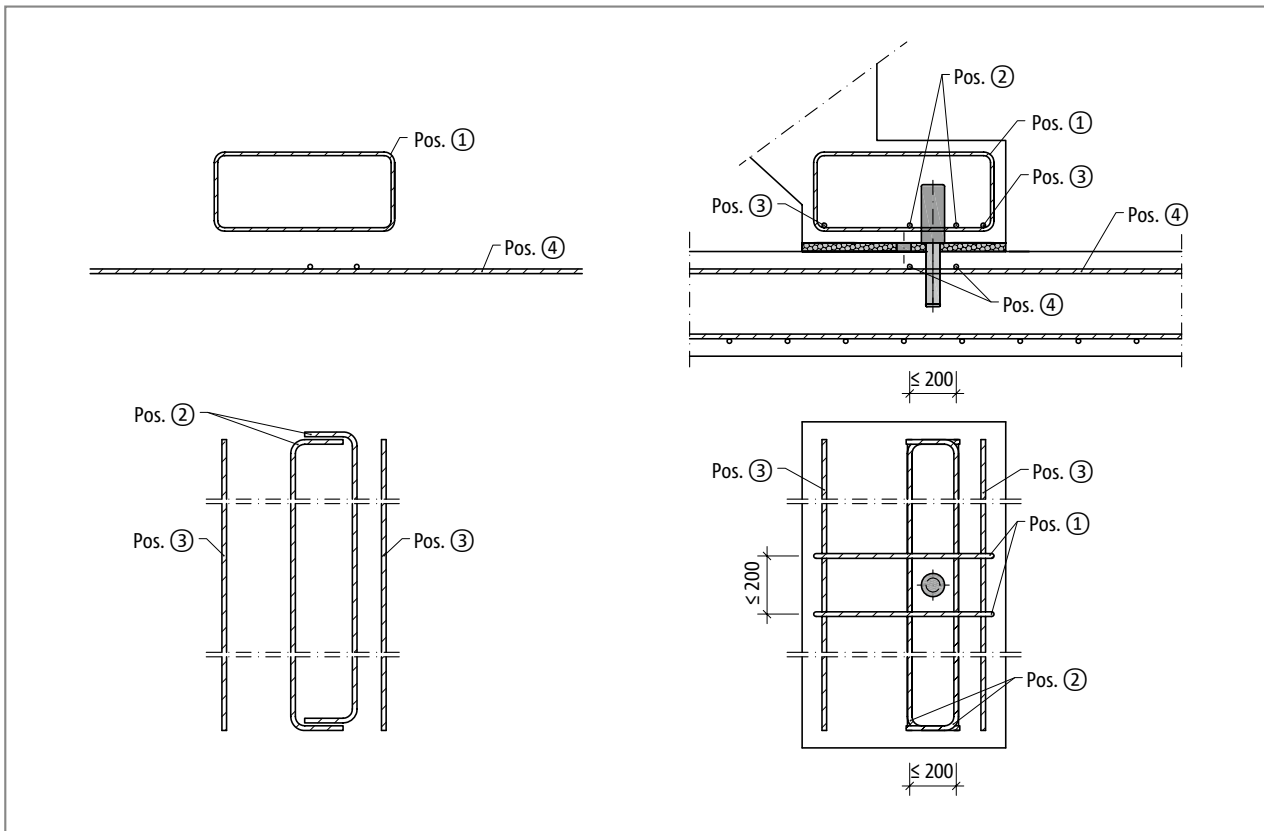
Schöck Tronsole® Typ D: Bauseitige Armierung
